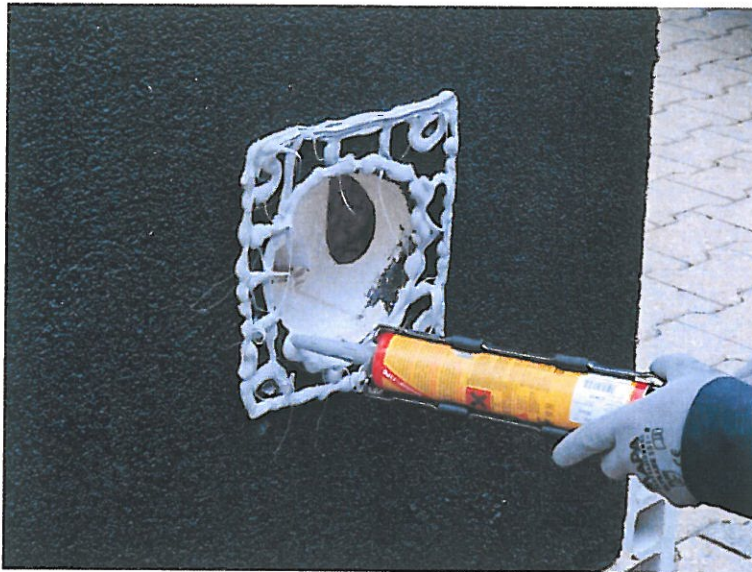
Dichtmasse Sikaflex 11 FC aufgebracht im Auflagerbereich der Flanschplatte (Bild Hauff-Technik GmbH & Co. KG)
